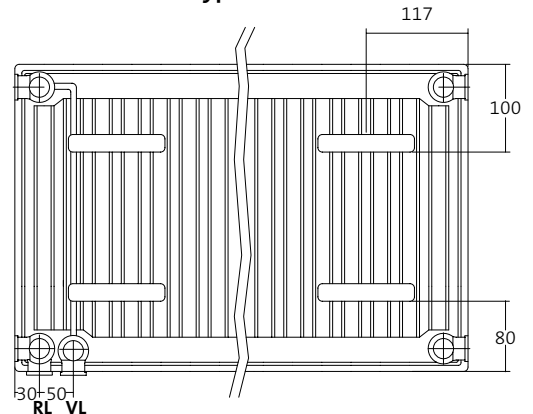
Laschenmaße für Plan Ventil Compact Typ 11 und Ramo Ventil Compact Typ 11 mit Befestigungslaschen (Rückansicht)
